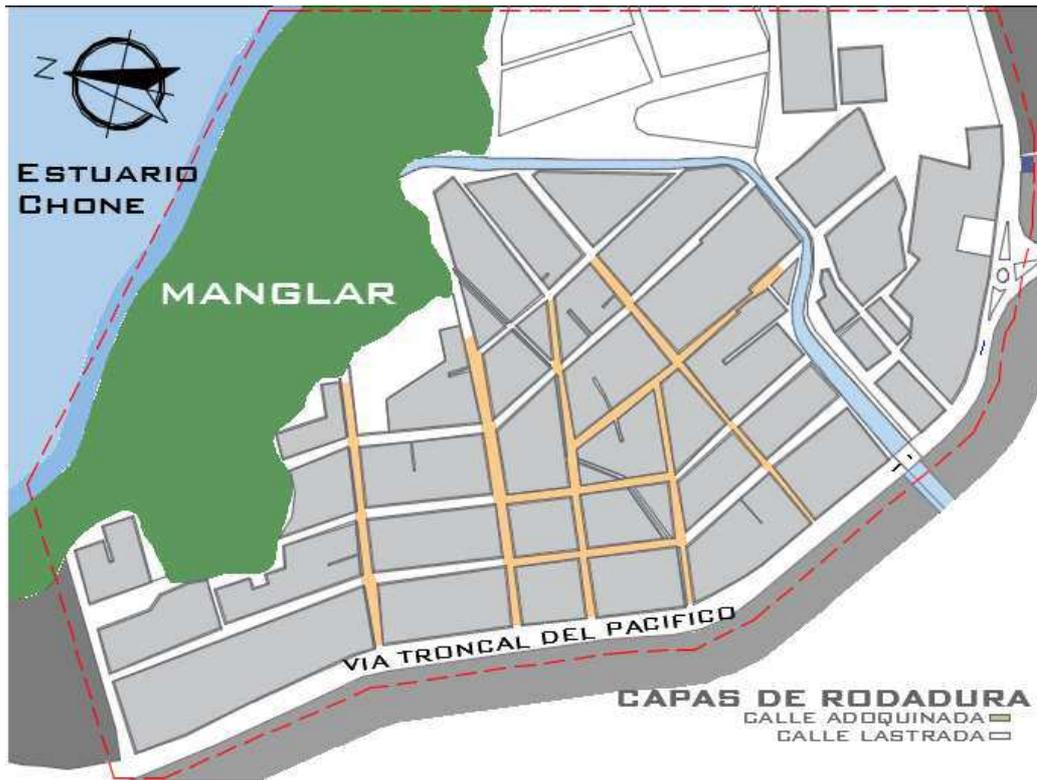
Plano Capas de Rodadura – Elaborado por Tesista
